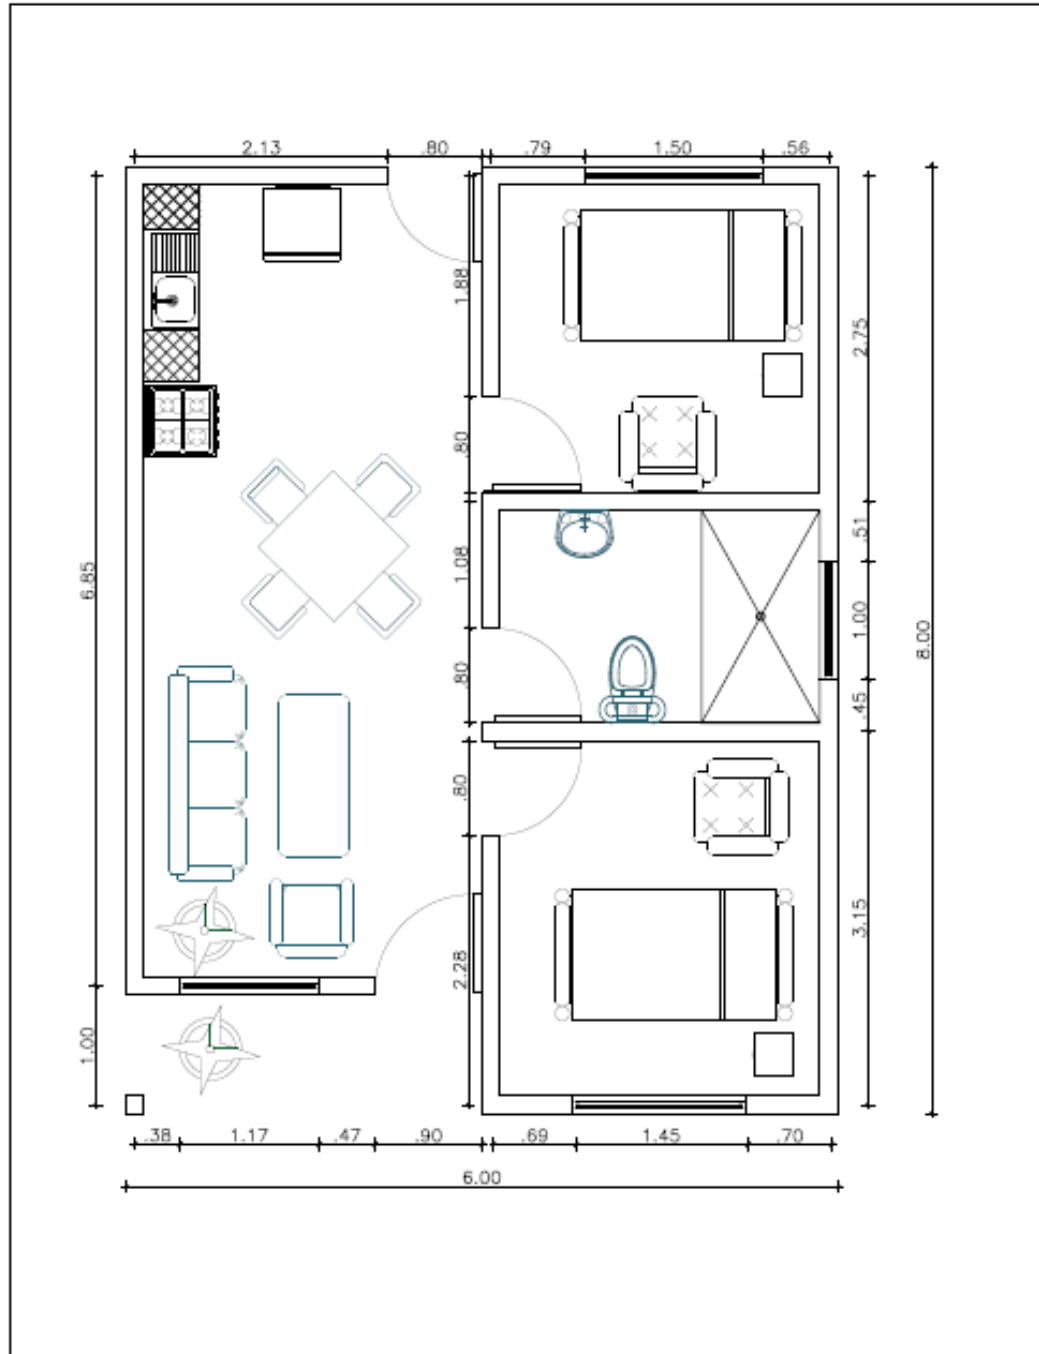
VISTA EN PLANTA VIVIENDA EN MADERA
